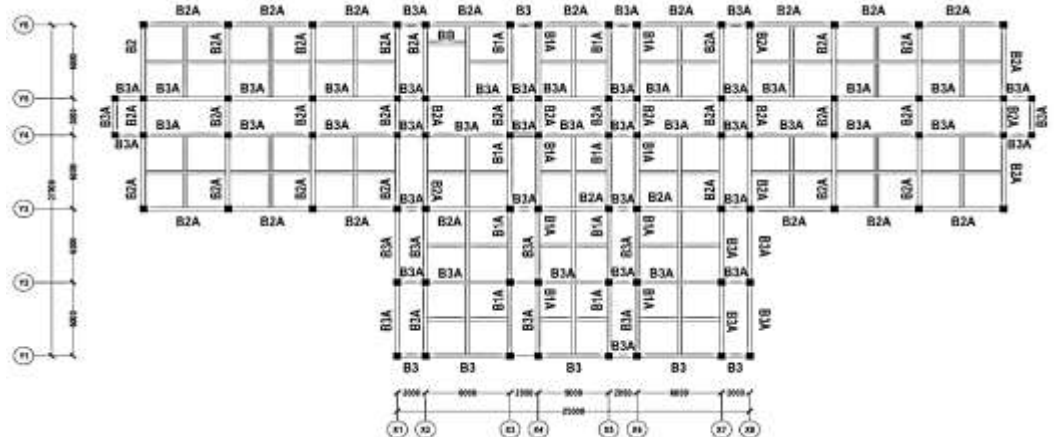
Denah Kolom Lantai 2 Gedung Balai Latihan Kerja (BLK)
